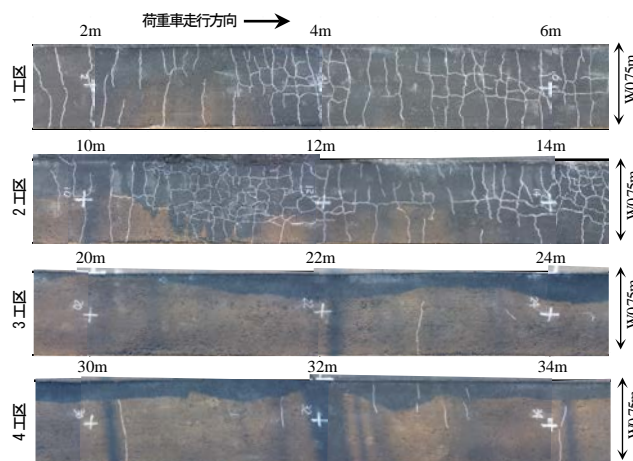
48,100輪時のひび割れ状況 (各工区代表箇所)
